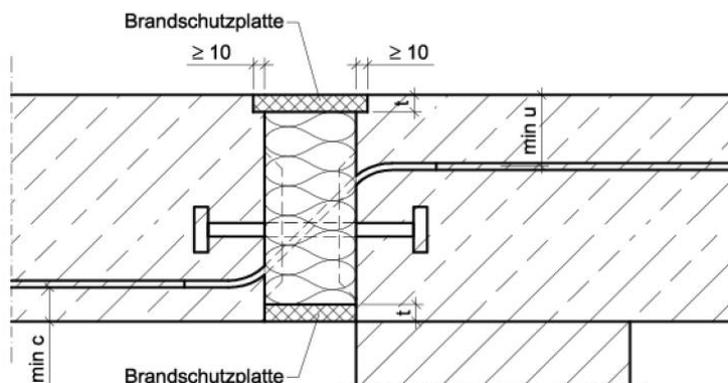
Schöck Isokorb® Typ Q mit SCE
